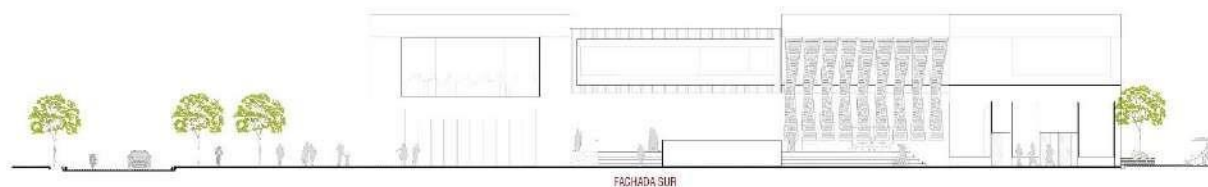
Fachada sur del proyecto (Fuente: Elaboración propia)
